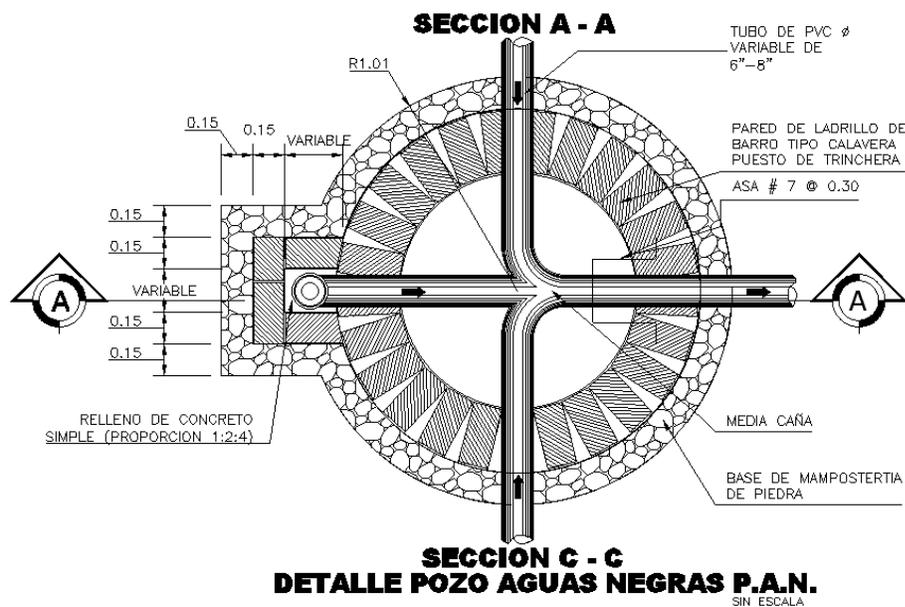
2 Detalle en sección en la parte inferior de un pozo de visita
